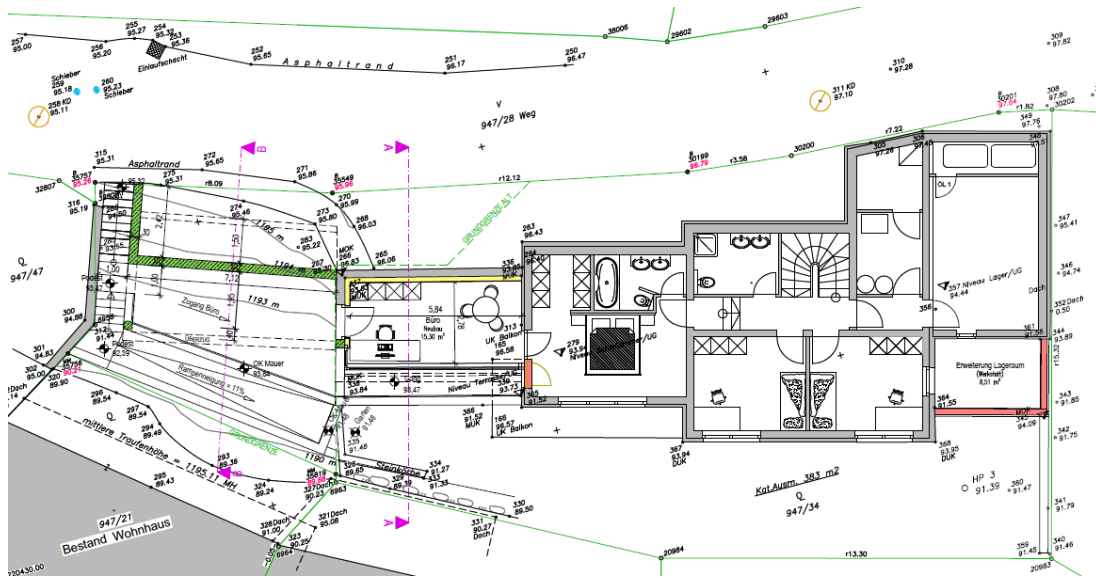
Untergeschoß 1 des geplanten Zubauvorhabens am Bestandsgebäude auf der Gp. 947/34 seitens des Planungsbüros R&S Planbau mit der Projektnummer „21-029“ und dem Plandatum 23.03.2022 (ohne Maßstab).
